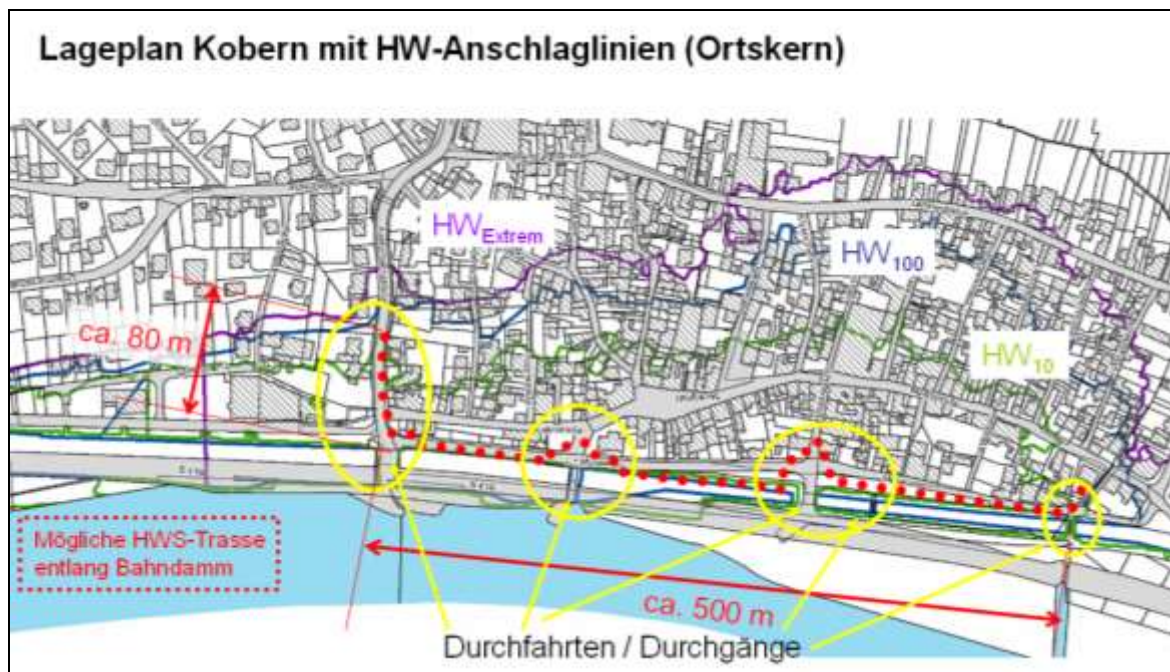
Lageplan Kobern mit Linienführung HWS-Wand im Moselweg, Skizze
